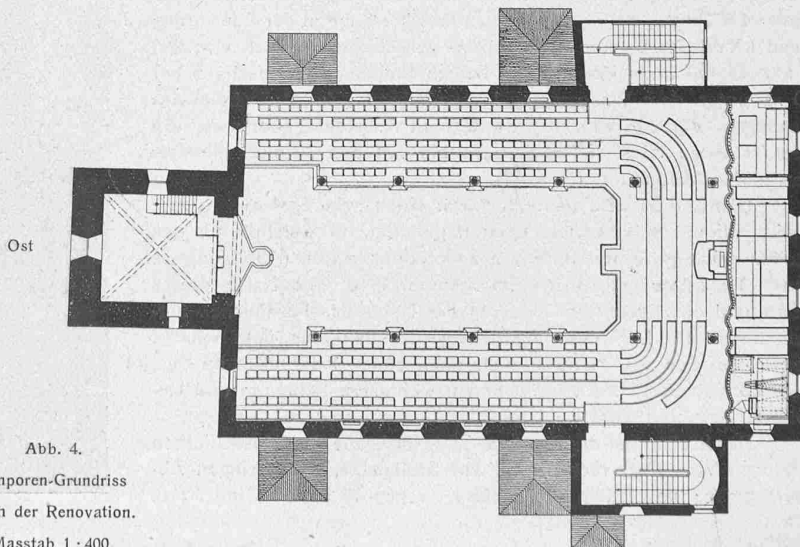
Emporen-Grundriss nach der Renovation. Masstab 1 : 400.
